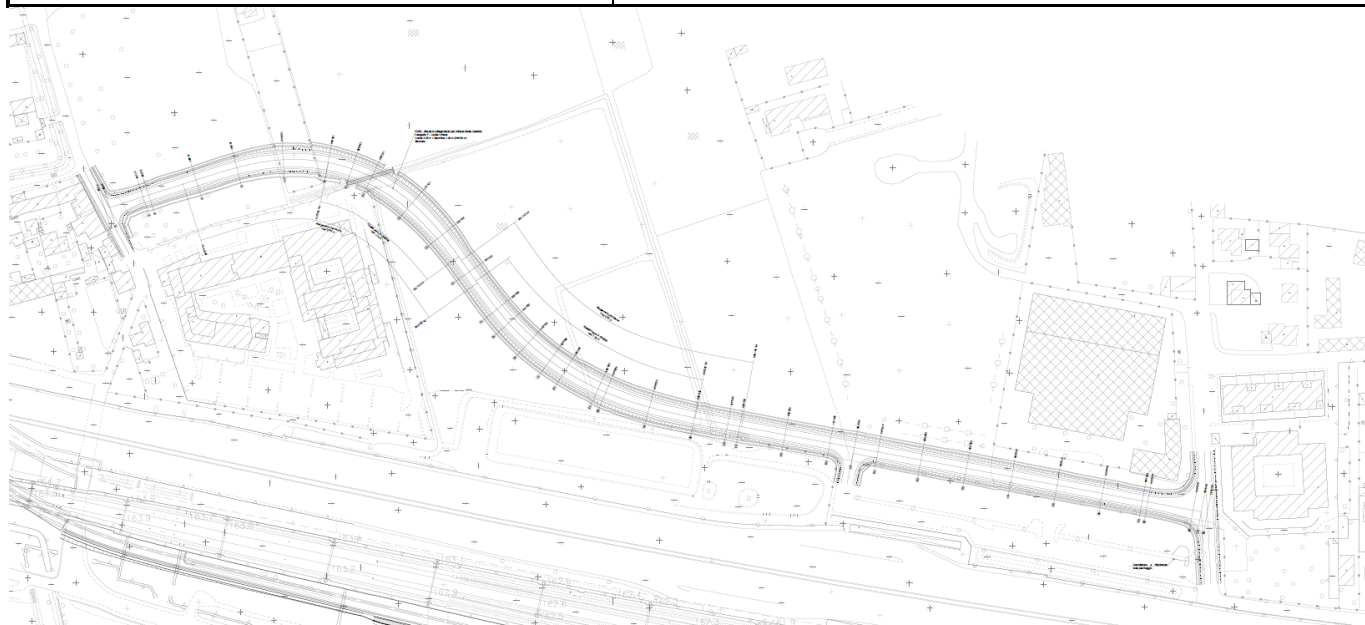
TRACCIATO PLANIMETRICO VIABILITÀ NV03
